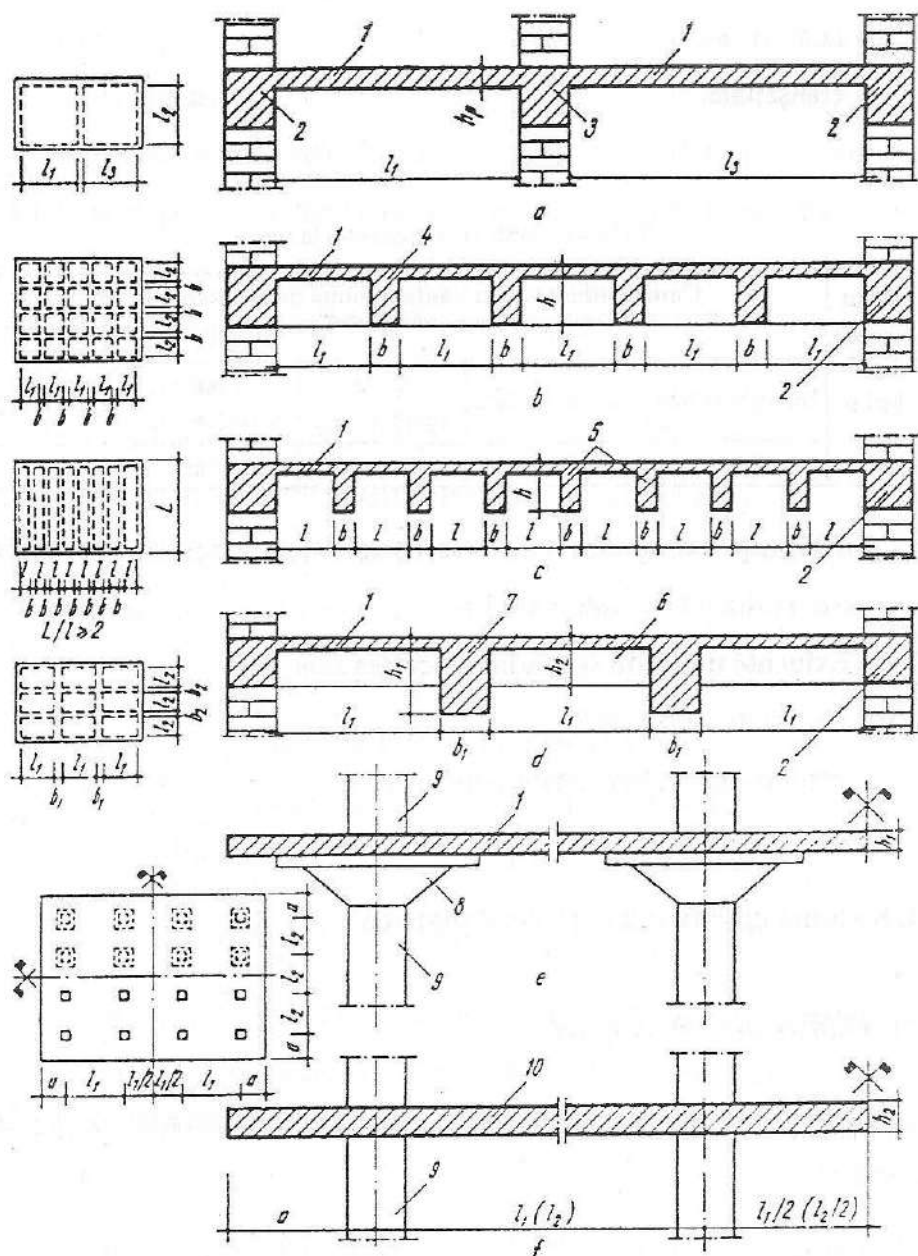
Plan și secțiuni pentru diverse tipuri de planșee din beton armat monolit:
